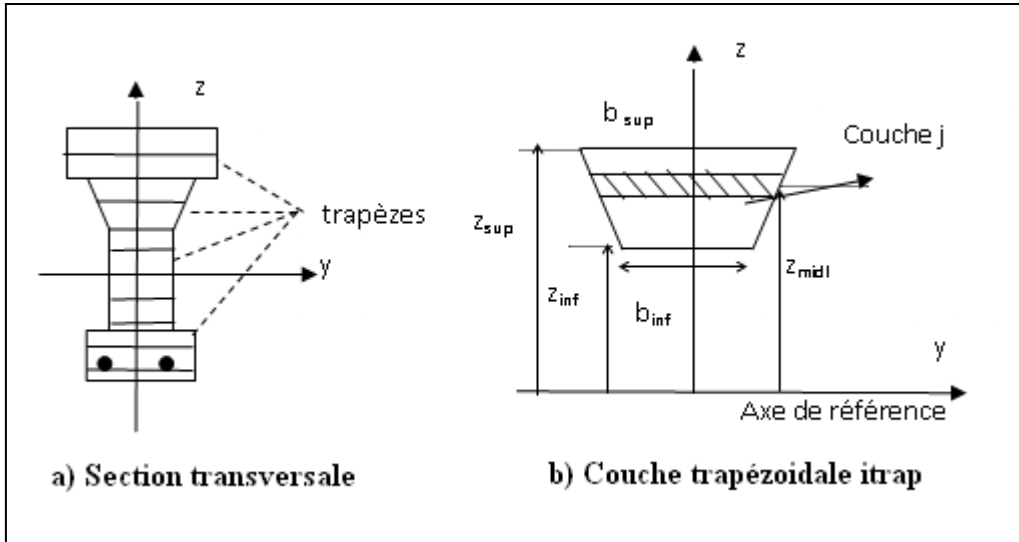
Discretisation de la section transversale en couches trapézoïdales.
